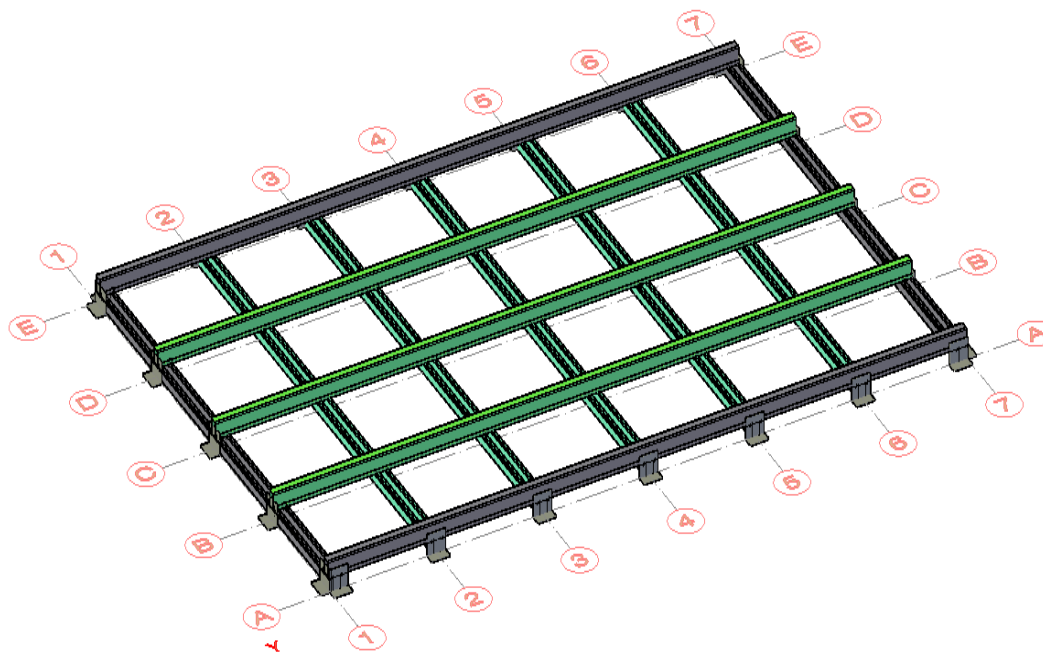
Isometría de unión de los perfiles Omega en Panel Doble
